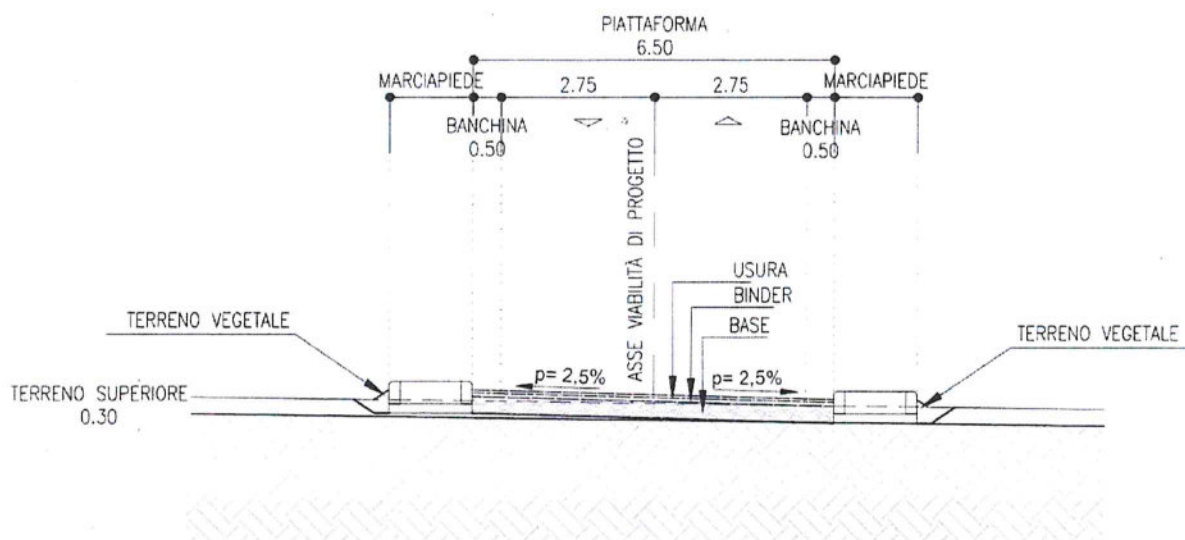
NV05 – Sezione tipica di Via L.Fava
